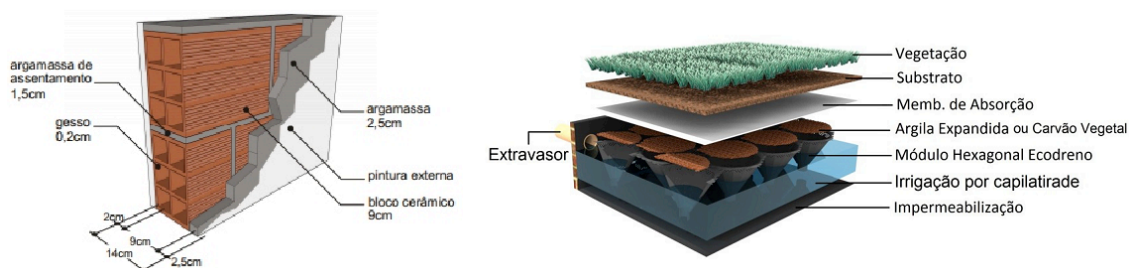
Parede Externa e Cobertura utilizados no preenchimento da planilha do Web Prescritivo para Salvador, BA.
